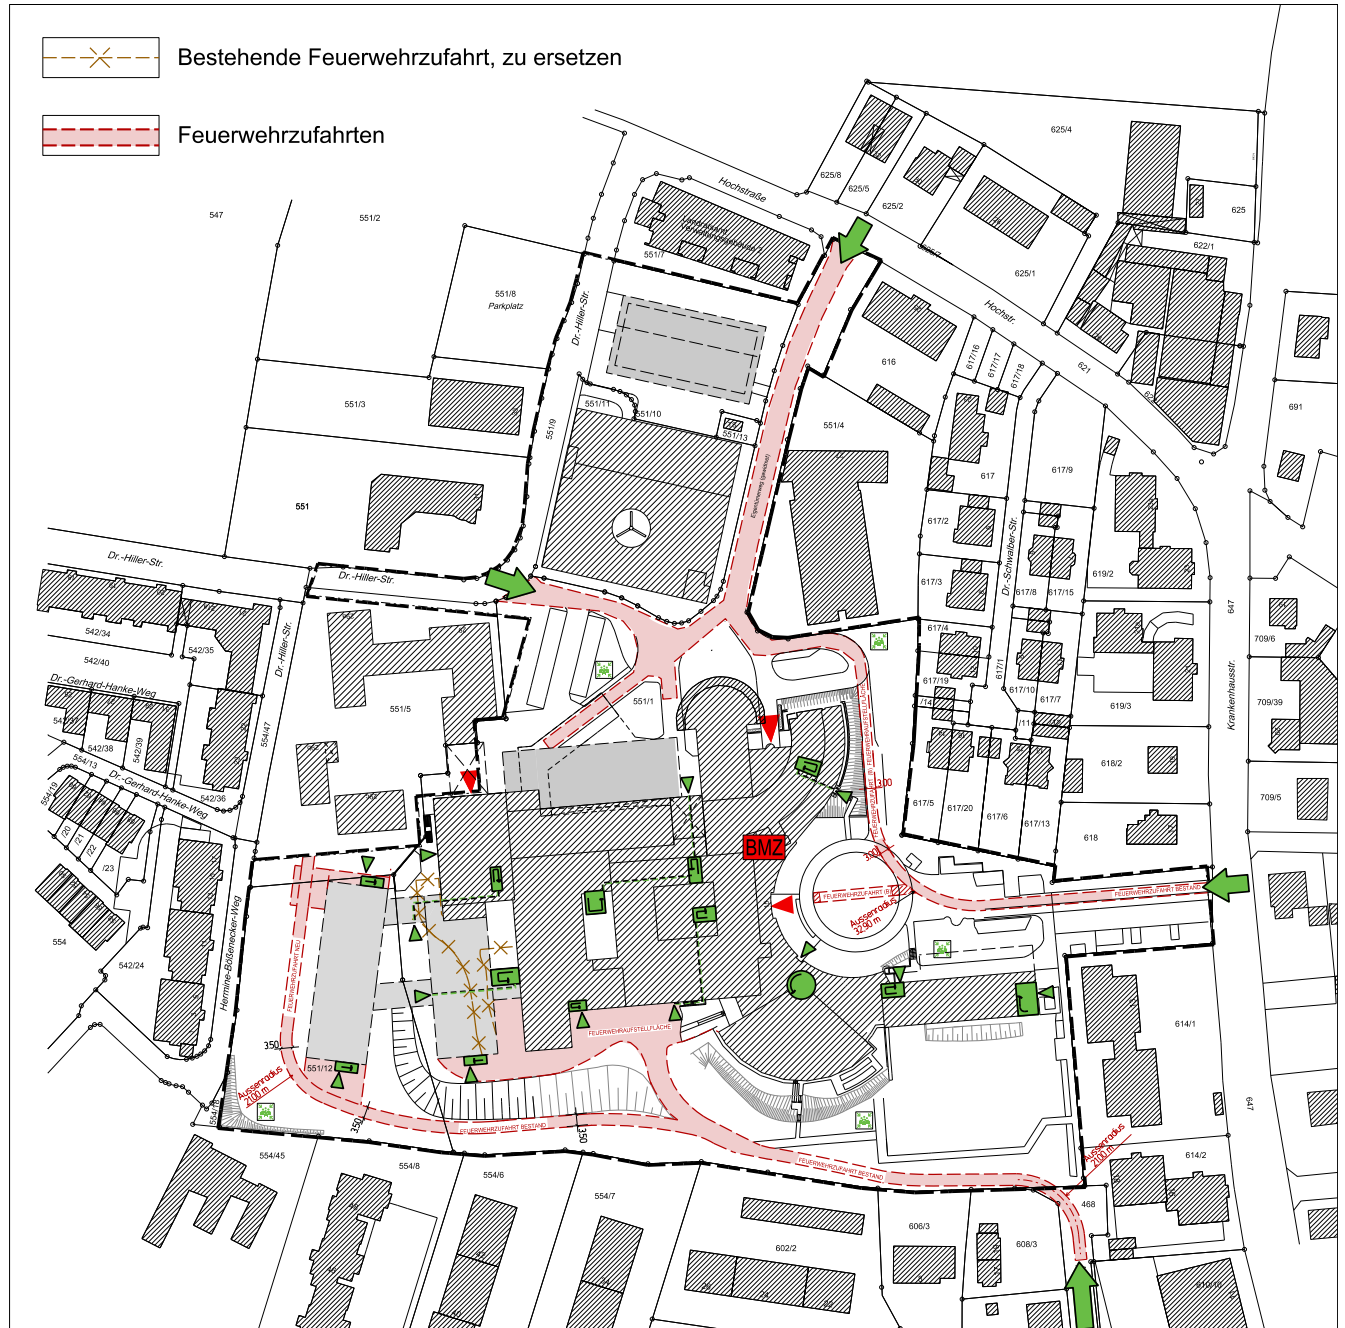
Lageplan Übersicht Brandschutz / Feuerwehzufahrt, ohne Maßstab
